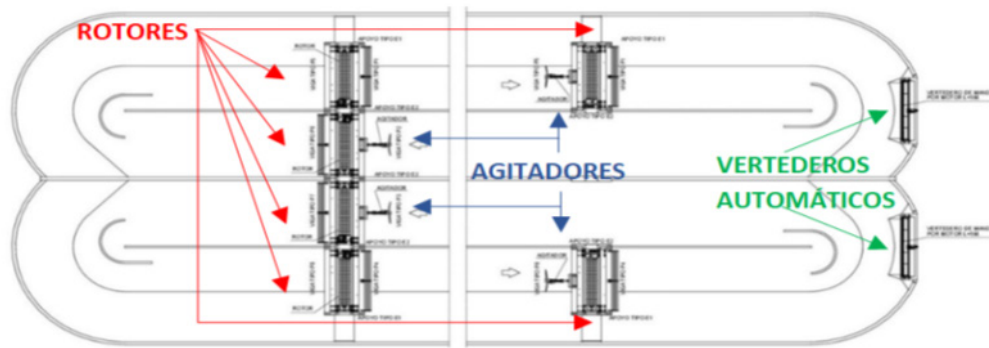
| Planta de los tanques de aireación con equipos instalados (Fuente: elaboración propia a partir de los planos del Proyecto constructivo de la EDAR)
